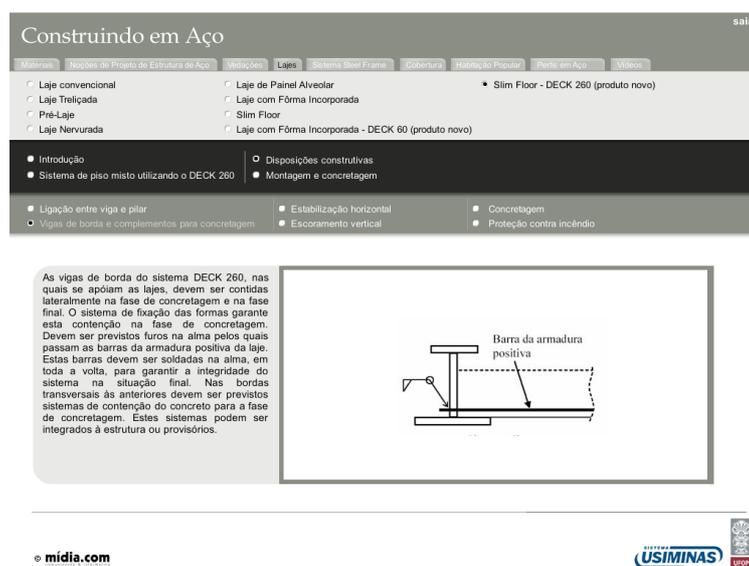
Disposições construtivas - Vigas de borda e complementos para a concretagem
